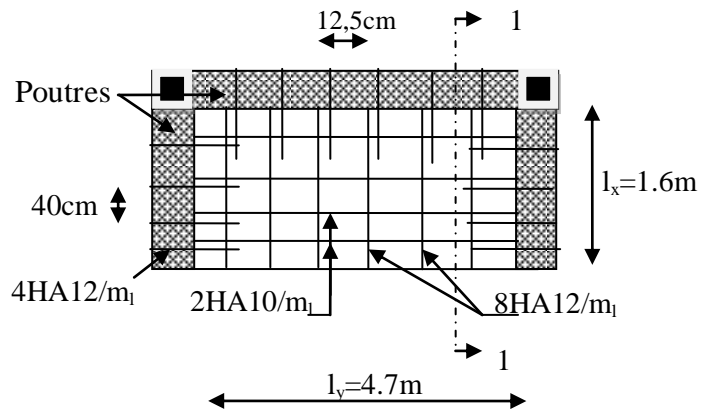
schéma de ferrailage de la dalle sur 3 appuis.
